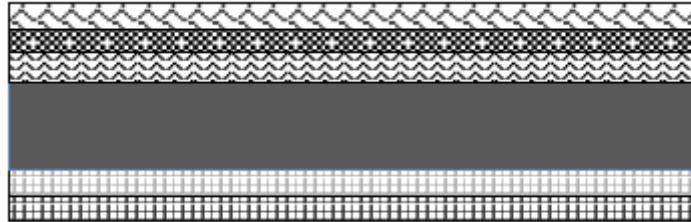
Plancher corps creux.I.4.2.2. Dalle pleine :
